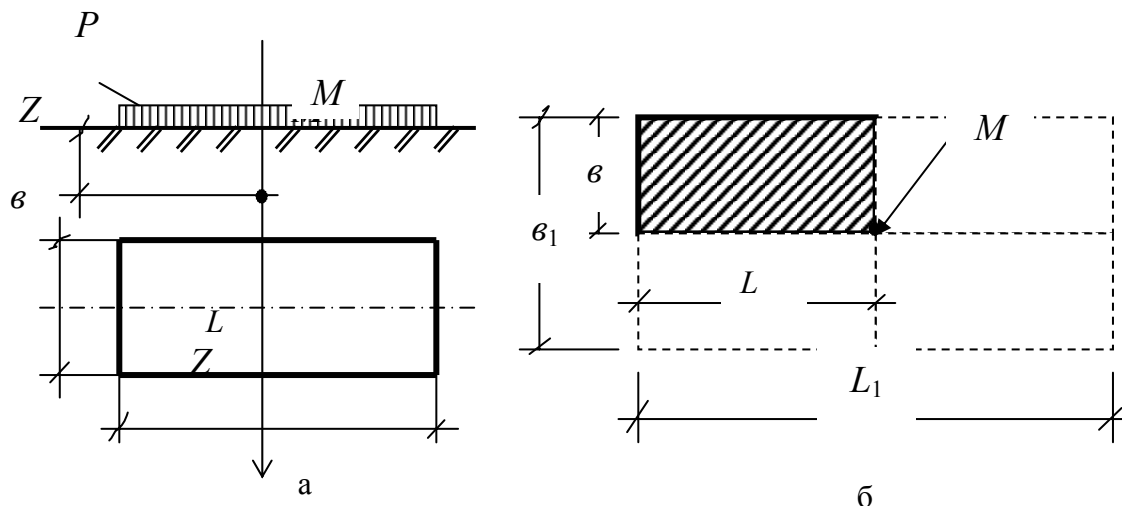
Расчетные схемы к определению напряжений σ_z при действии местного равномерно распределенного давления: а – для точек, расположенных под центром прямоугольной площади загрузки; б – под угловыми точками прямоугольной площади загрузки
